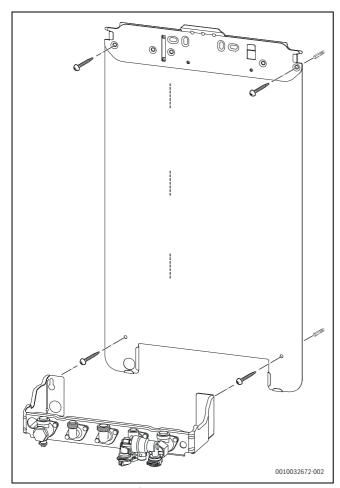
Instalar a placa de fixação e a placa de ligação para montagem
